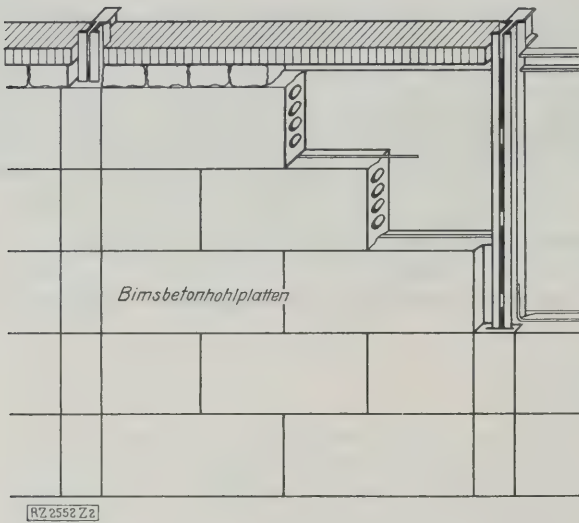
Stahlskelettwand mit Bimsbeton-Hohlplatten.
